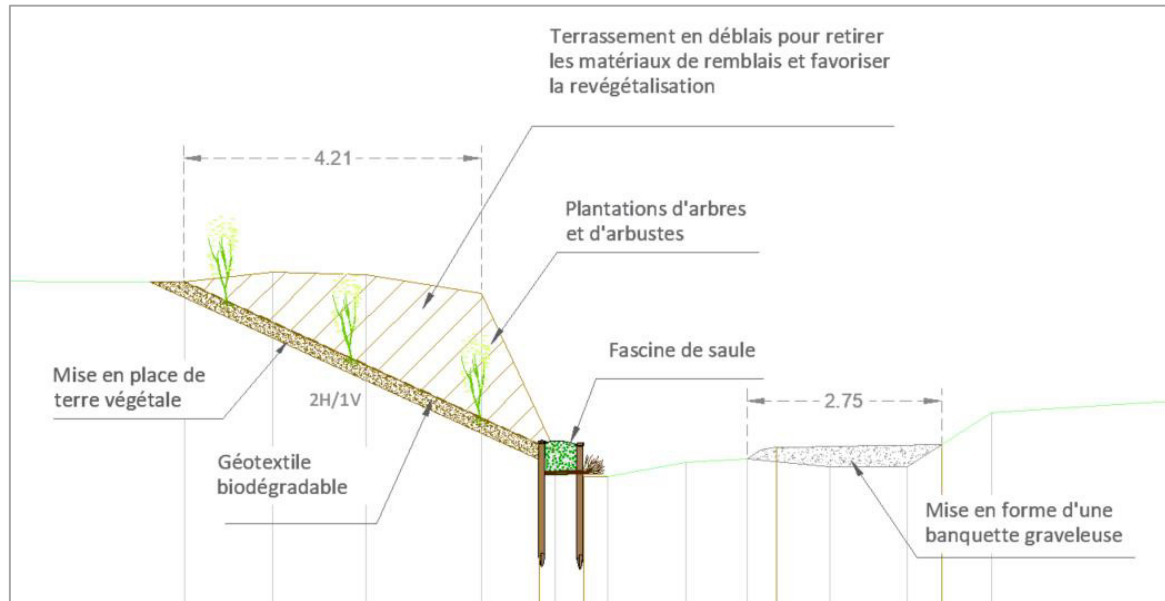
Profil illustrant le reprofilage de la berge et la protection du pied
